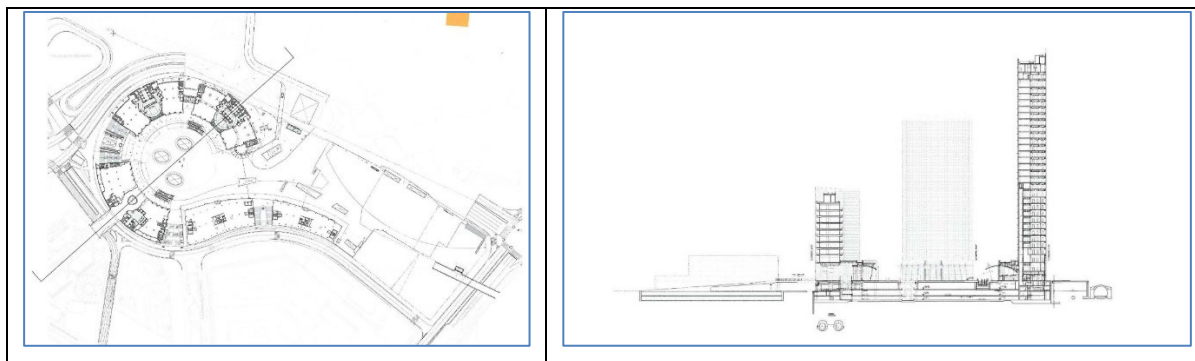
Pianta e sezione del podio di piazza Gae Aulenti
